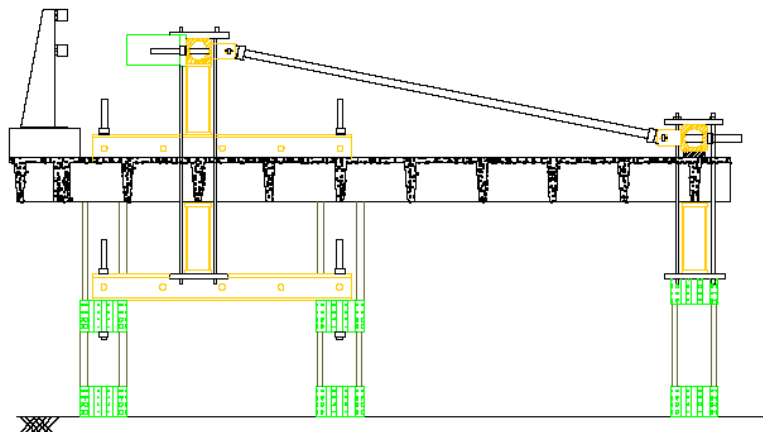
Bâti pour essai de rupture du dispositif de retenu
